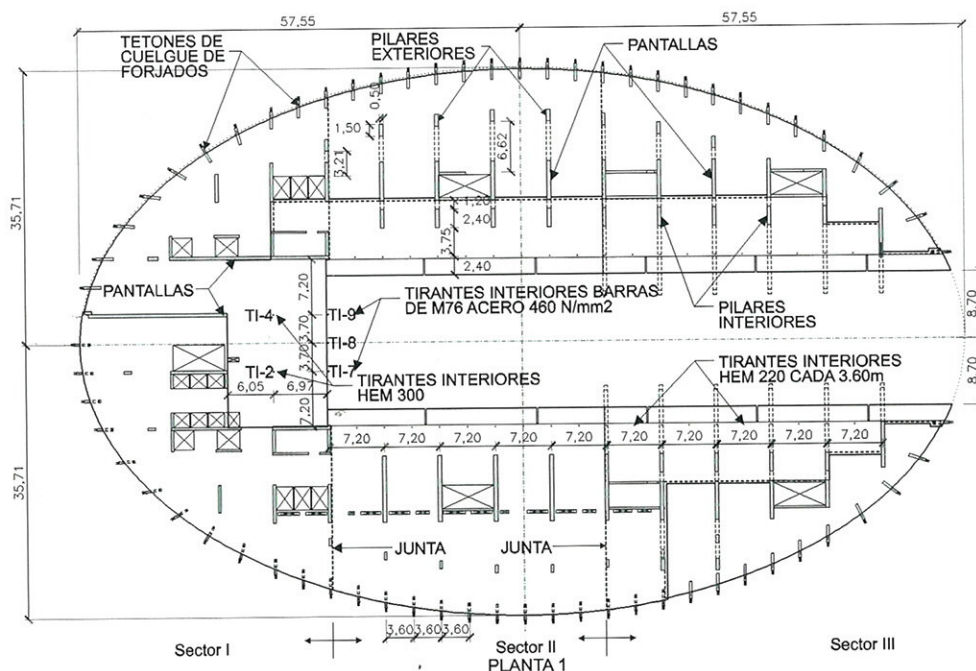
Planta 1. Forjado elíptico de semieje mayor 57,55 m y 35,71 m de semieje menor.
